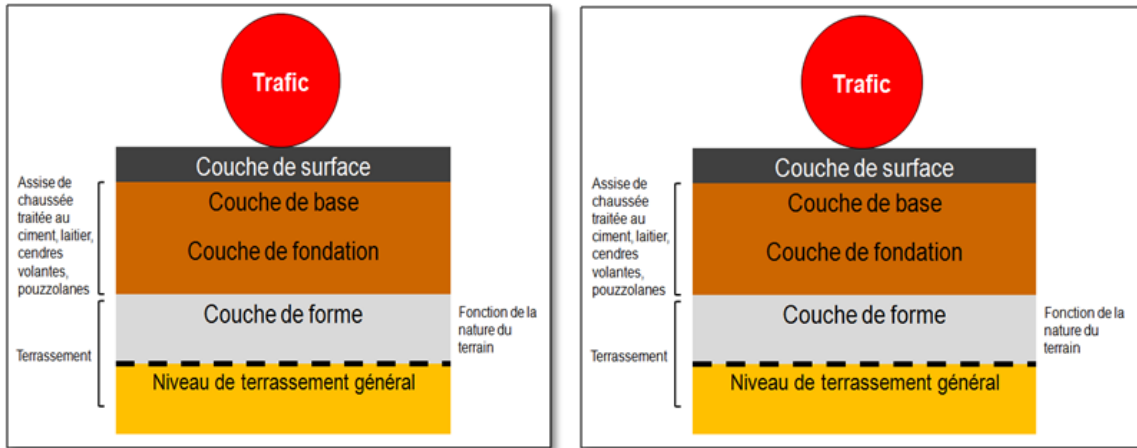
Structure type d'une chaussée semi-rigide.
